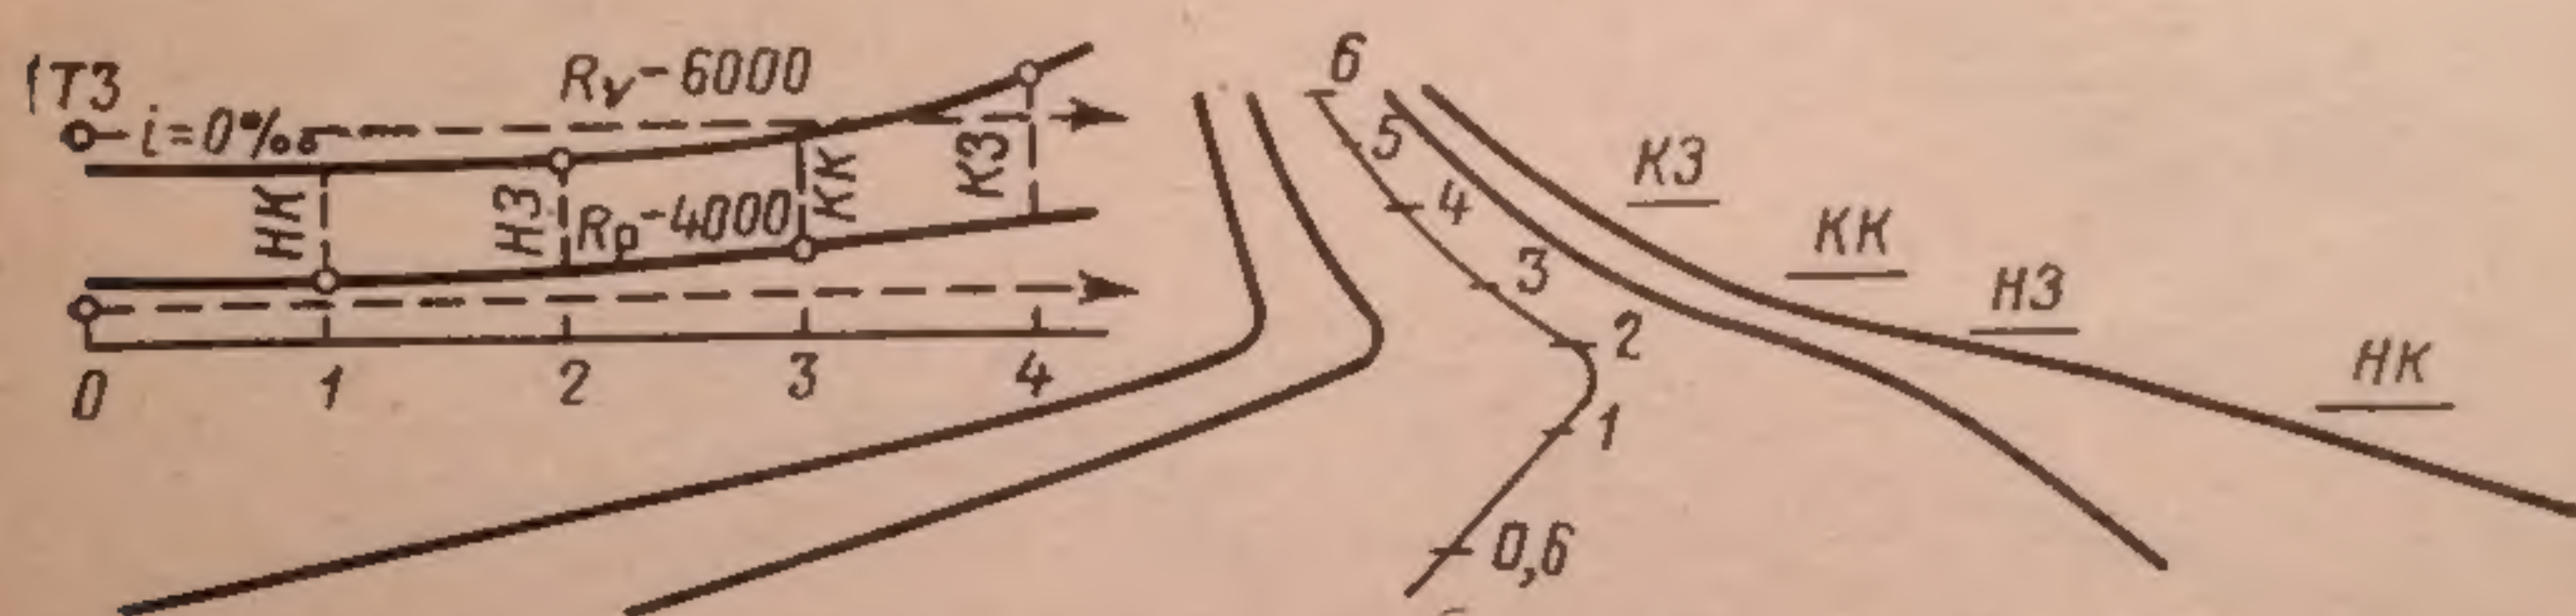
Смещенное сочетание кривой в плане с вертикальной кривой
